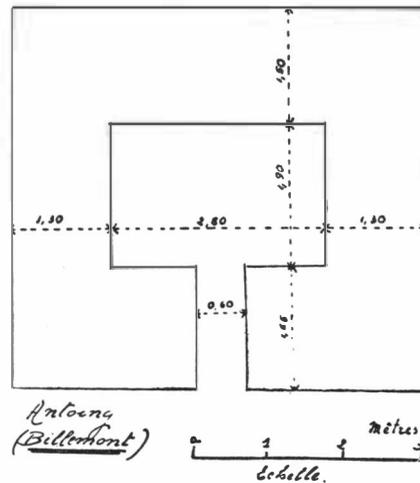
Plan du caveau en pierres trouvé à Guéronde-Antoing en 1913-1914.
